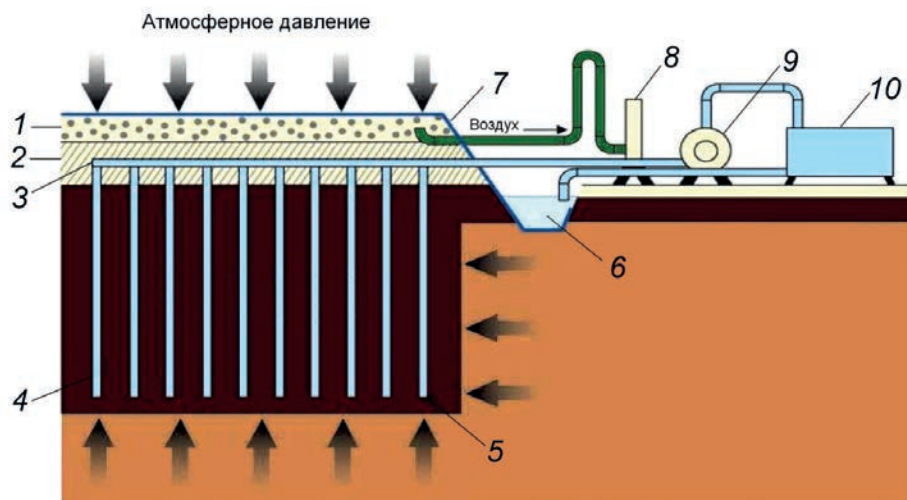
Принципиальная схема вакуумирования слабых грунтов компании Menard [11]: 1 – насыпь; 2 – дренарующий слой; 3 – горизонтальные дренаи; 4 – цилиндрические дренажные трубы; 5 – дренажная скважина; 6 – траншея, заполненная бентонитом и полиакрилатом; 7 – геомембрана; 8 – бустер; 9 – вакуумный насос; 10 – водоочистная станция
